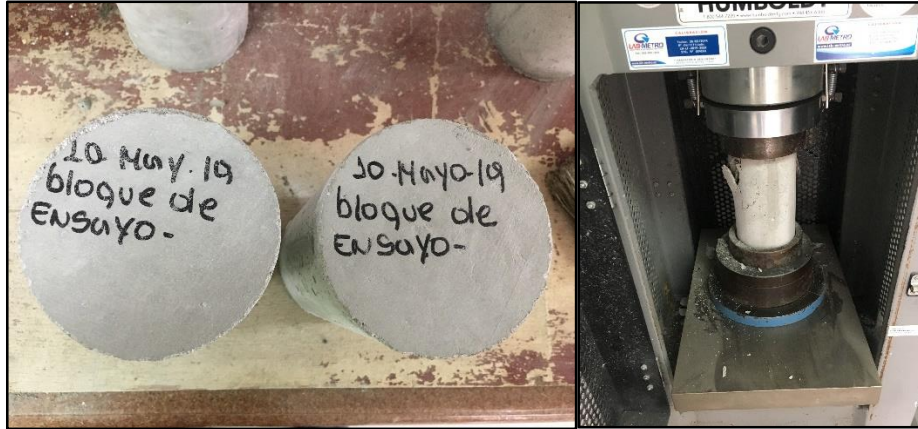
Rotura de cilindros de hormigón. Fuente del autor.
